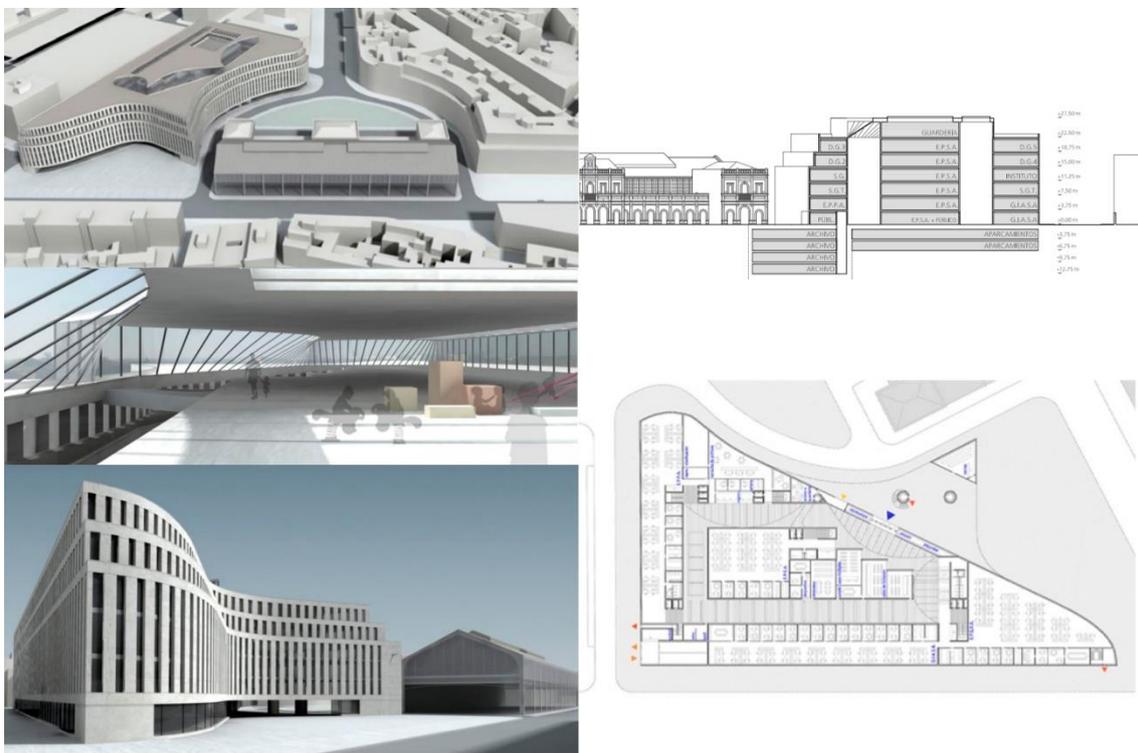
Vistas exteriores, vista interior, planta y sección.
